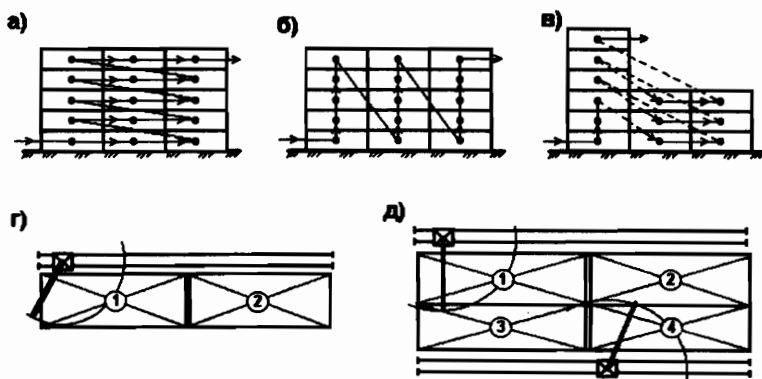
Технологические схемы возведения многоэтажных промышленных зданий: а – горизонтально-восходящая; б – вертикально-восходящая; в – смешанная; г, д – схема размещения башенных кранов и деления объектов на монтажные участки (захватки)
